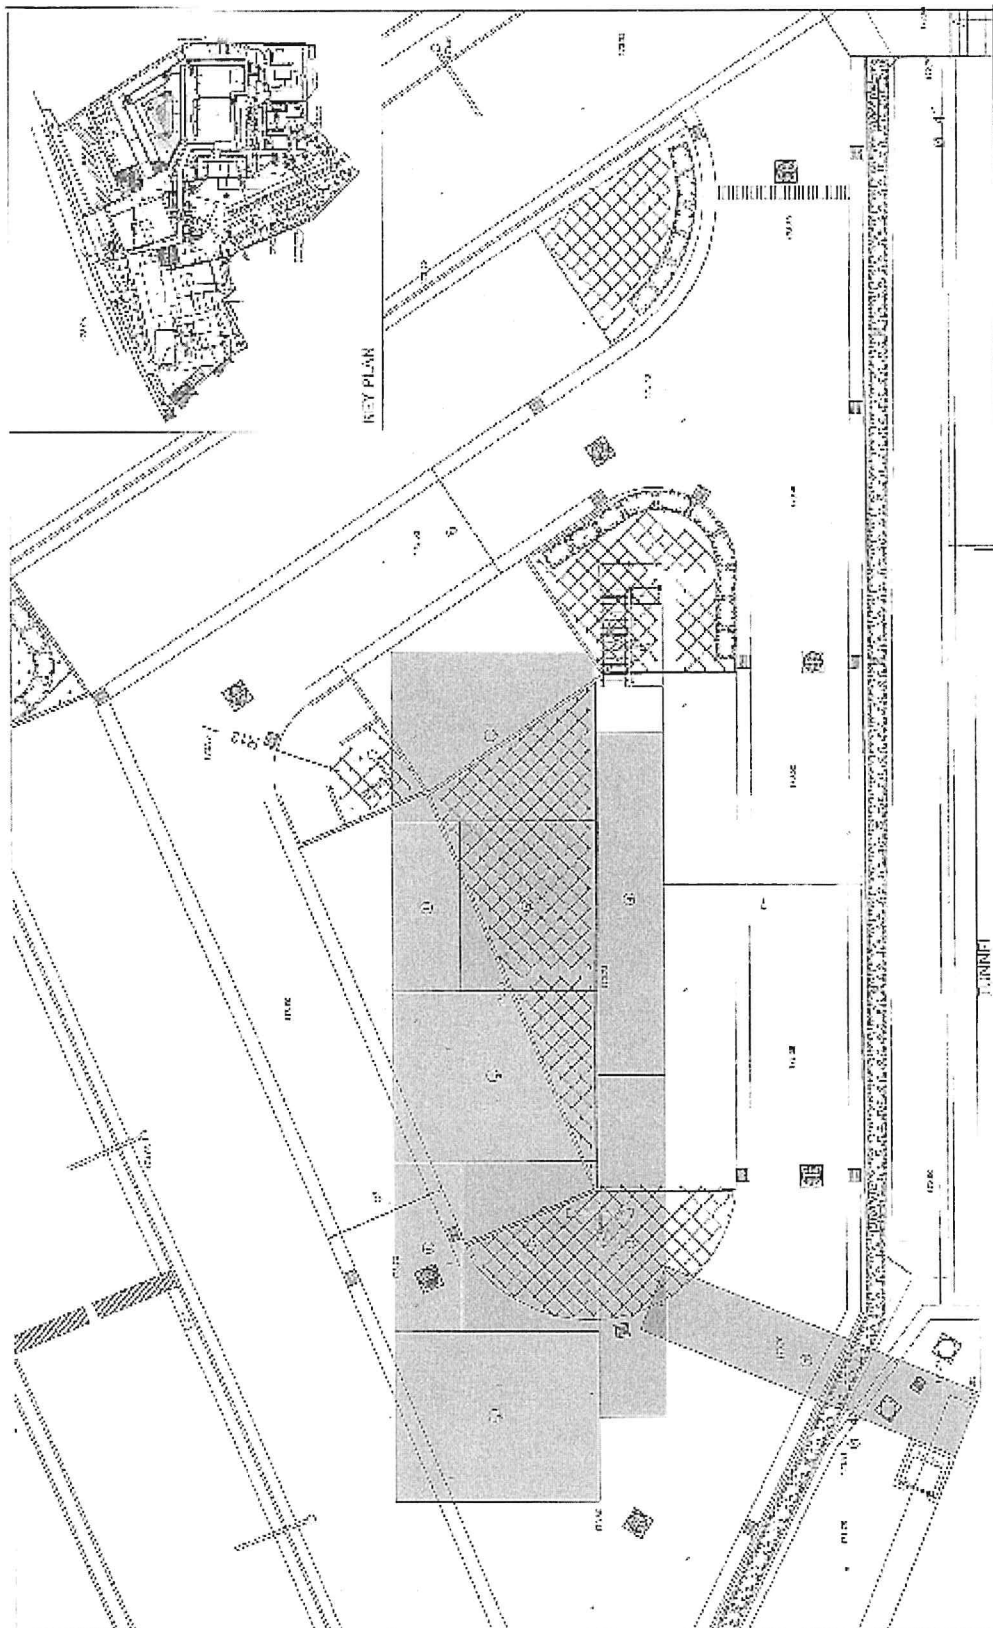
Posizionamento della struttura prefabbricata rispetto all'area rappresentata in Figura 1 ed al percorso protetto (indicato con TUNNEL in figura)
